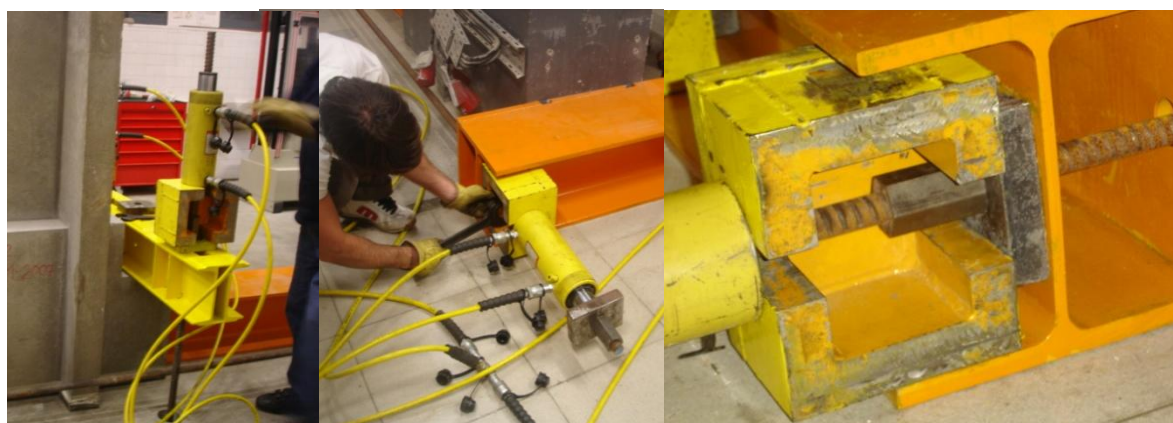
Fase de montagem do ensaio – Fixação do provete
